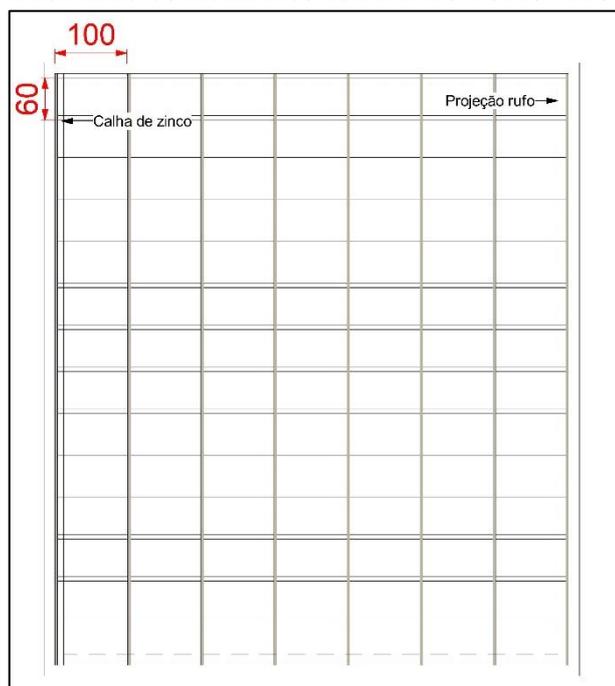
Planta de cobertura embutida com telha fibrocimento
